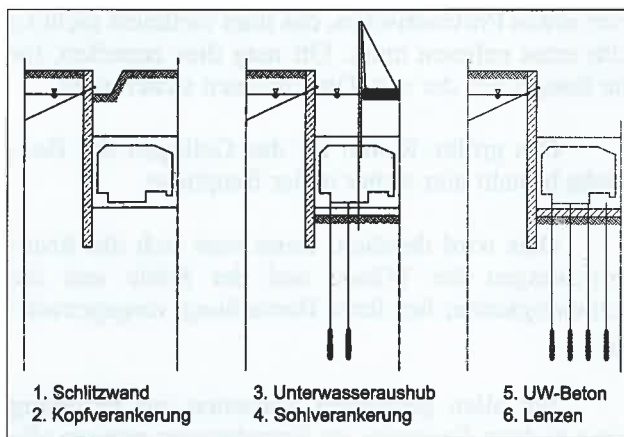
Bauphasen für Baugruben mit rückverankerter, hochliegender Unterwasserbetonsohle
